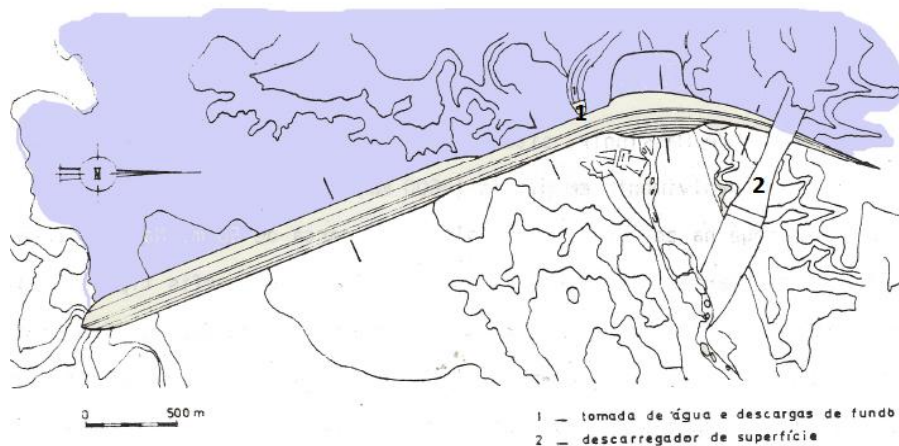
Planta da barragem antes da reabilitação (LNEC, 2011).
